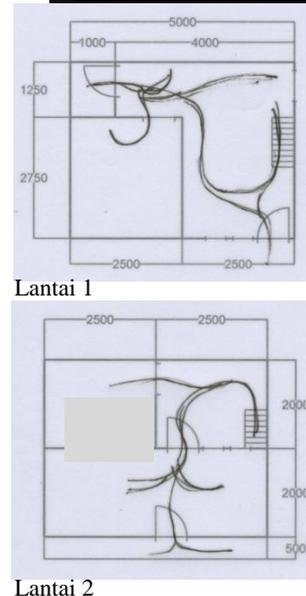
Denah lantai 1 rumah mbak Amn
